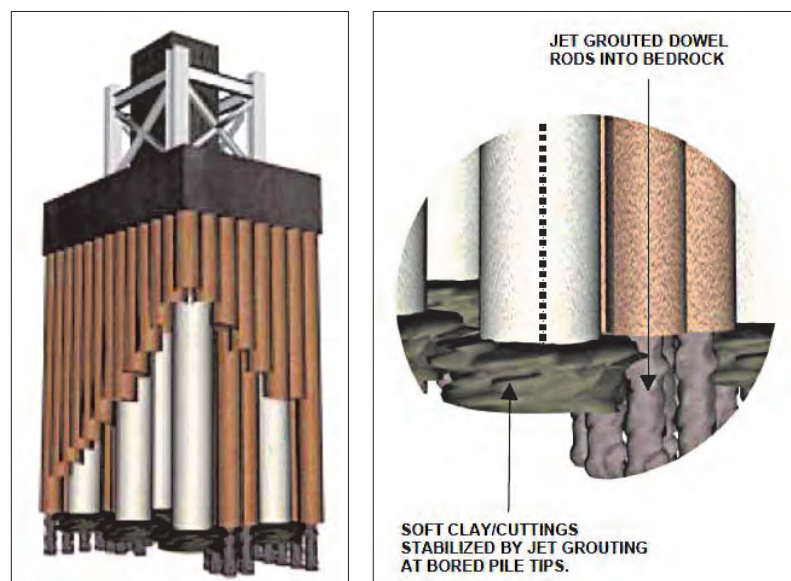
REFUERZO DE PILOTAJE MEDIANTE JET-GROUTING Y CONFINAMIENTO CON DEEP-MIXING. PILA 161, TREN LIGERO, MANILA (Morales y Ono, 2004).
